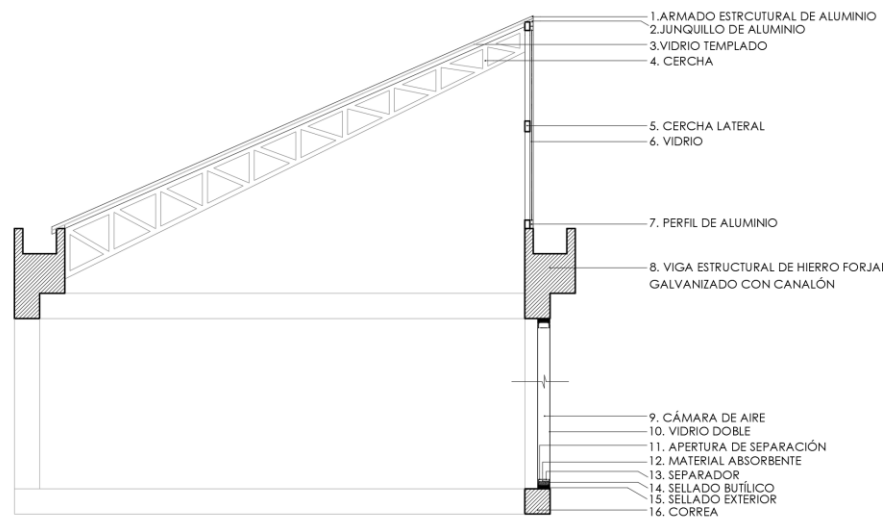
Detalle constructivo A-1 invernadero. Elaborado por el autor.
